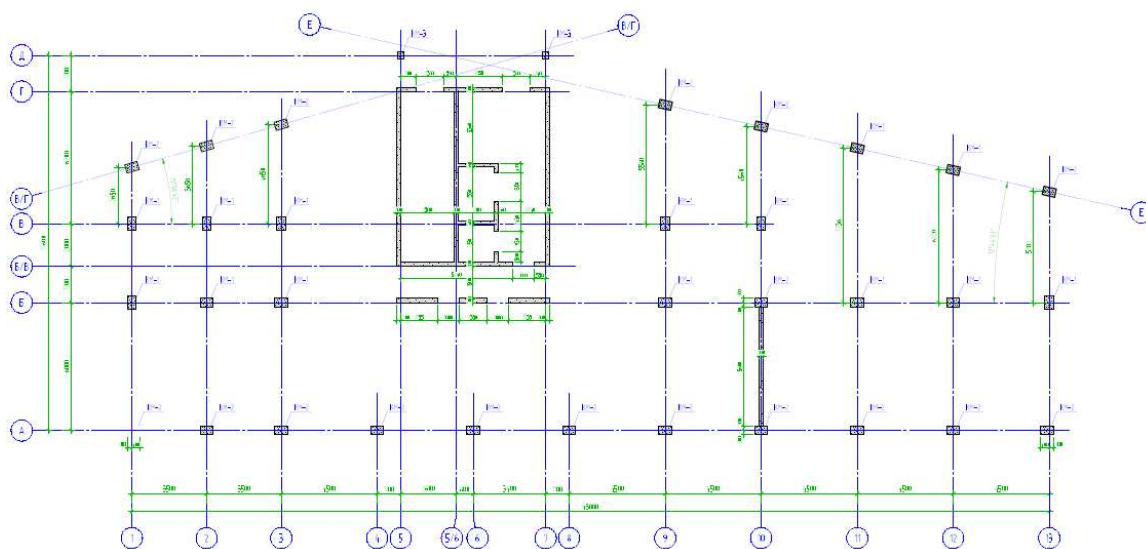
Рассматриваемая плита перекрытия на отм. +5,600
